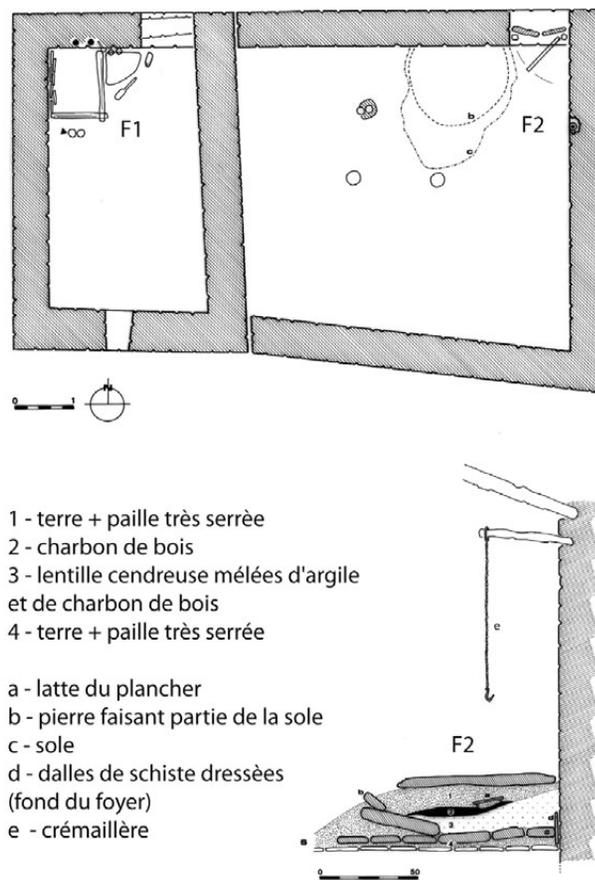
L'étage d'un *teccio* au hameau d'estive avec foyers à plat sur le plancher : plans, coupe du foyer F2, indication du mobilier.
